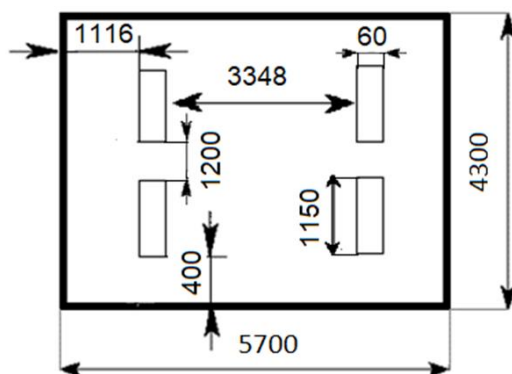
Схема размещения светильников в помещении
